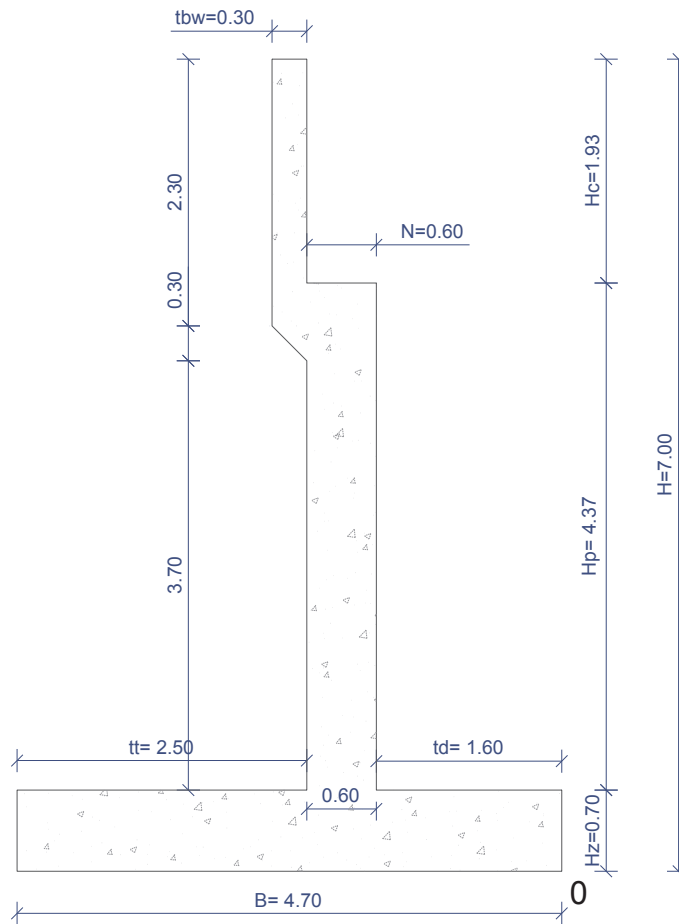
Dimensiones, elevación lateral del estribo.
